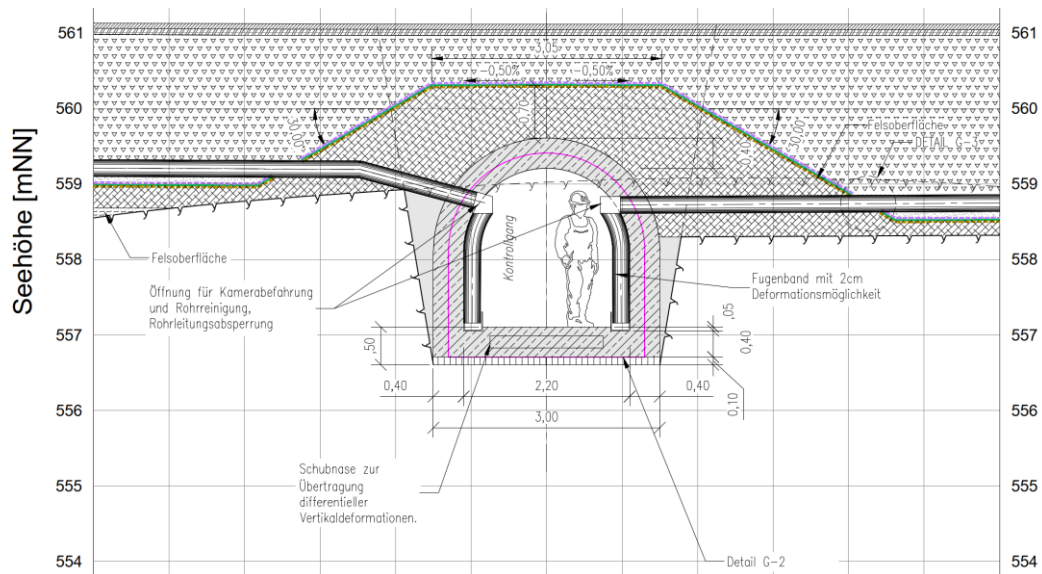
Regelquerschnitt Kontrollgang (Ausschnitt aus Plan [P18])
